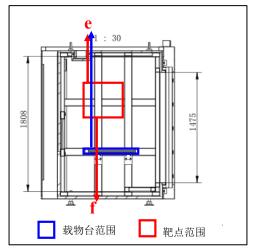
本项目探伤铅房剖面布局与预测点位图(单位: mm)
